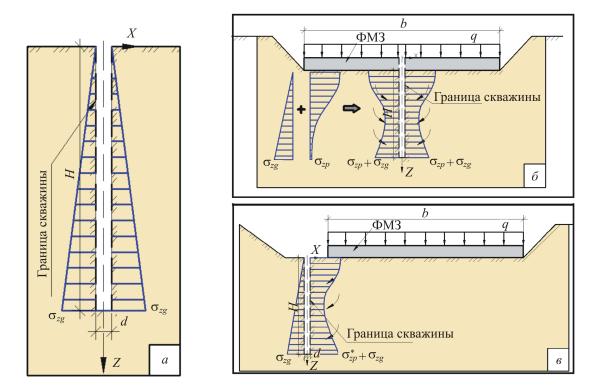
Расчетные случаи расположения цилиндрической полости относительно фундамента: a — одиночная скважина в грунте; δ — скважина под плитой фундамента; ϵ — скважина вне контура фундамента
